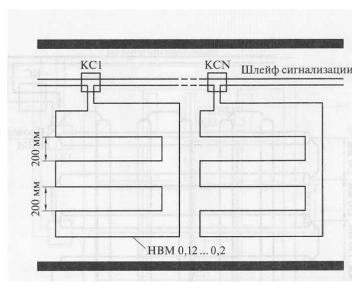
Схема блокировки стены (перегородки) на пролом с помощью омического (типа «Провод») извещателя: КСІ, КСN—коробки соединительные, устанавливаются через каждые 5 м² блокируемой поверхности.
